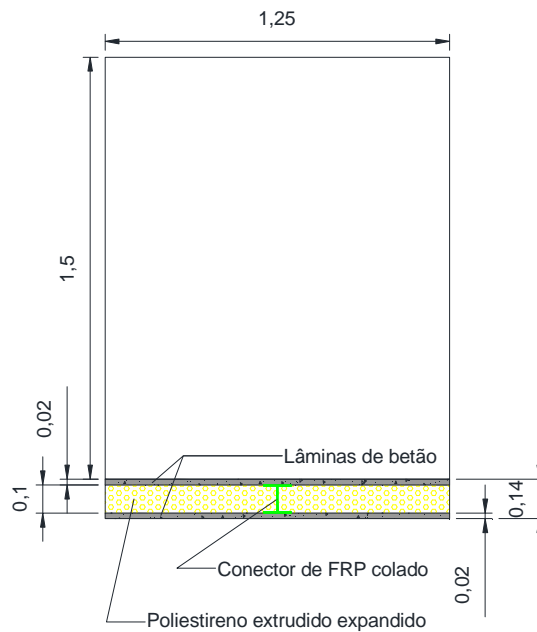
Geometria do painel sandwich com conectores perfil I colados de FRP e espessura da camada de betão de 20 mm (vista em planta, unidades em metros).
